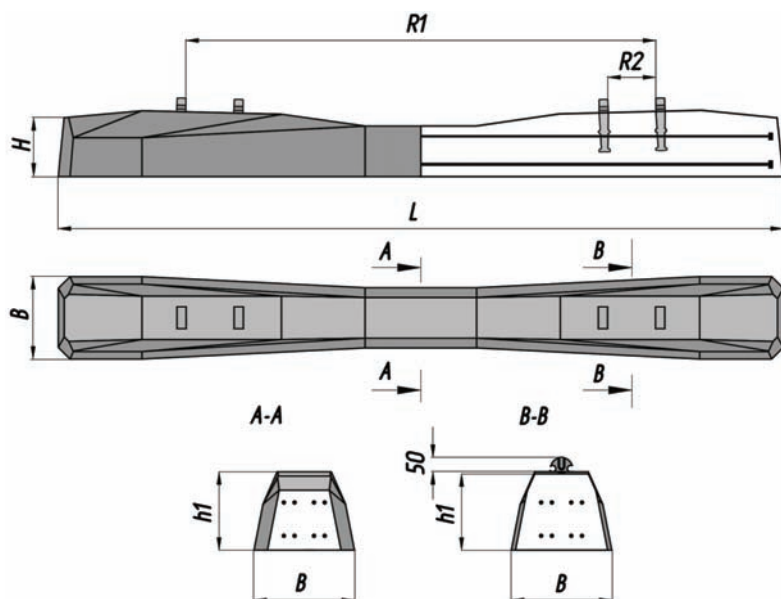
Podkład strunobetonowy PS83/K dla przytwierdzenia K (zmodernizowany INBK-7) [9]
